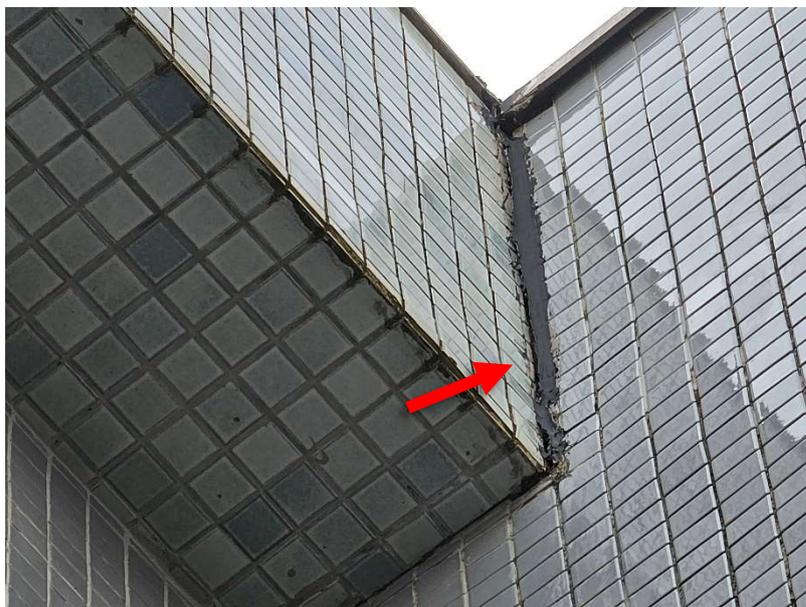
Foi constatada trinca entre o beiral da edificação principal e a alvenaria da passarela.
